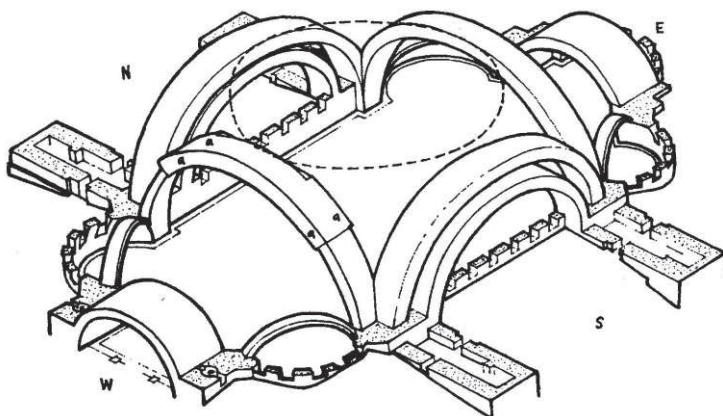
Esquema estructural de arcos de Santa Sofía. (Mainstone).
